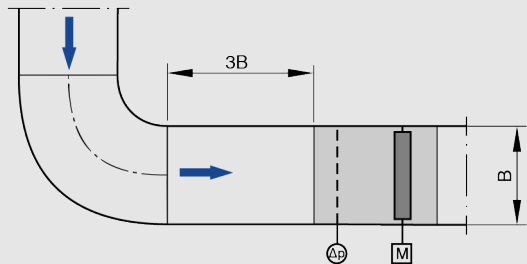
Raccordement horizontal du coude (vue du dessus)
